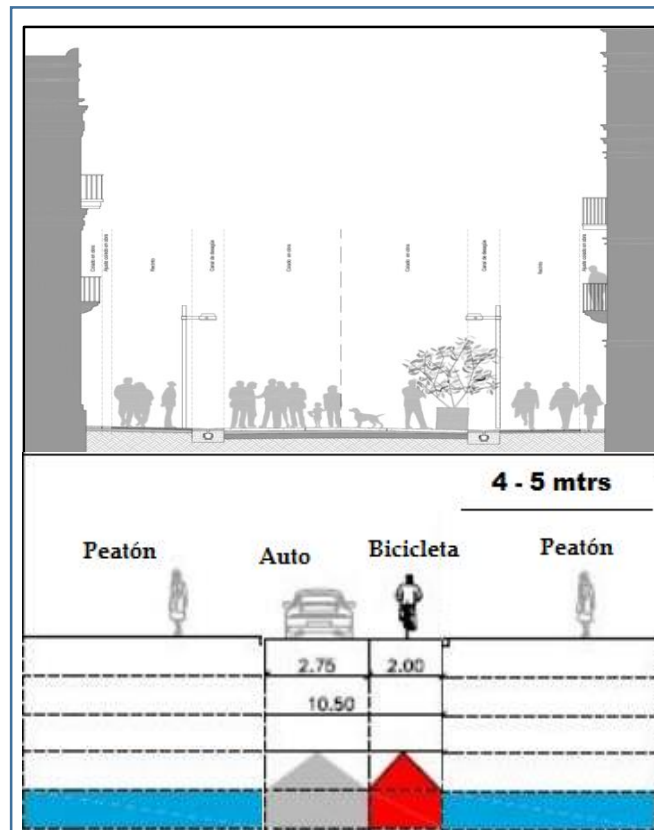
Modelo de Propuesta de intervención calle Primera Constituyente
